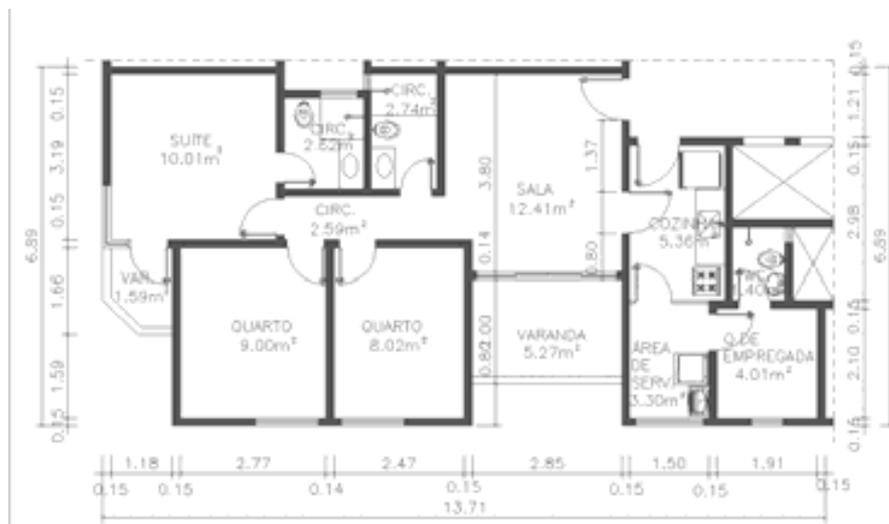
Projeto Original – SQSW 102 – Bloco F
